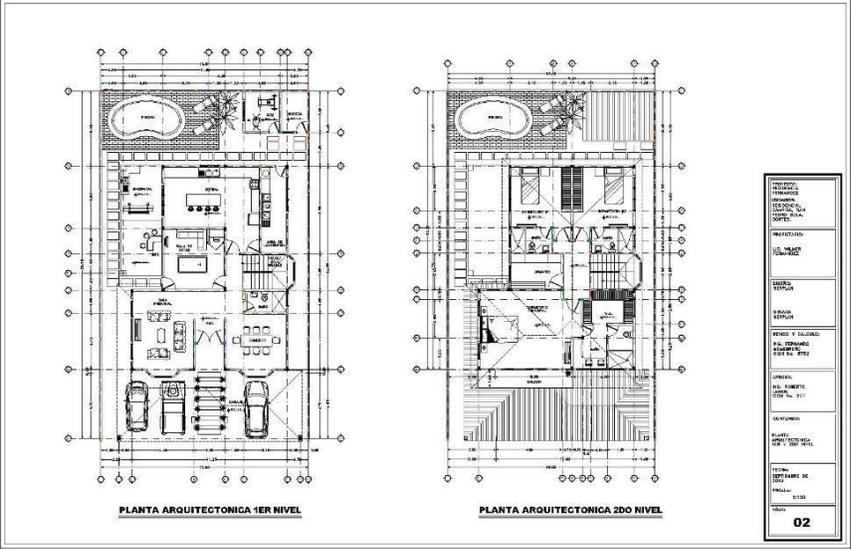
Plantas arquitectónicas Revisión 1, Vivienda Unifamiliar Wilmer Fernández
